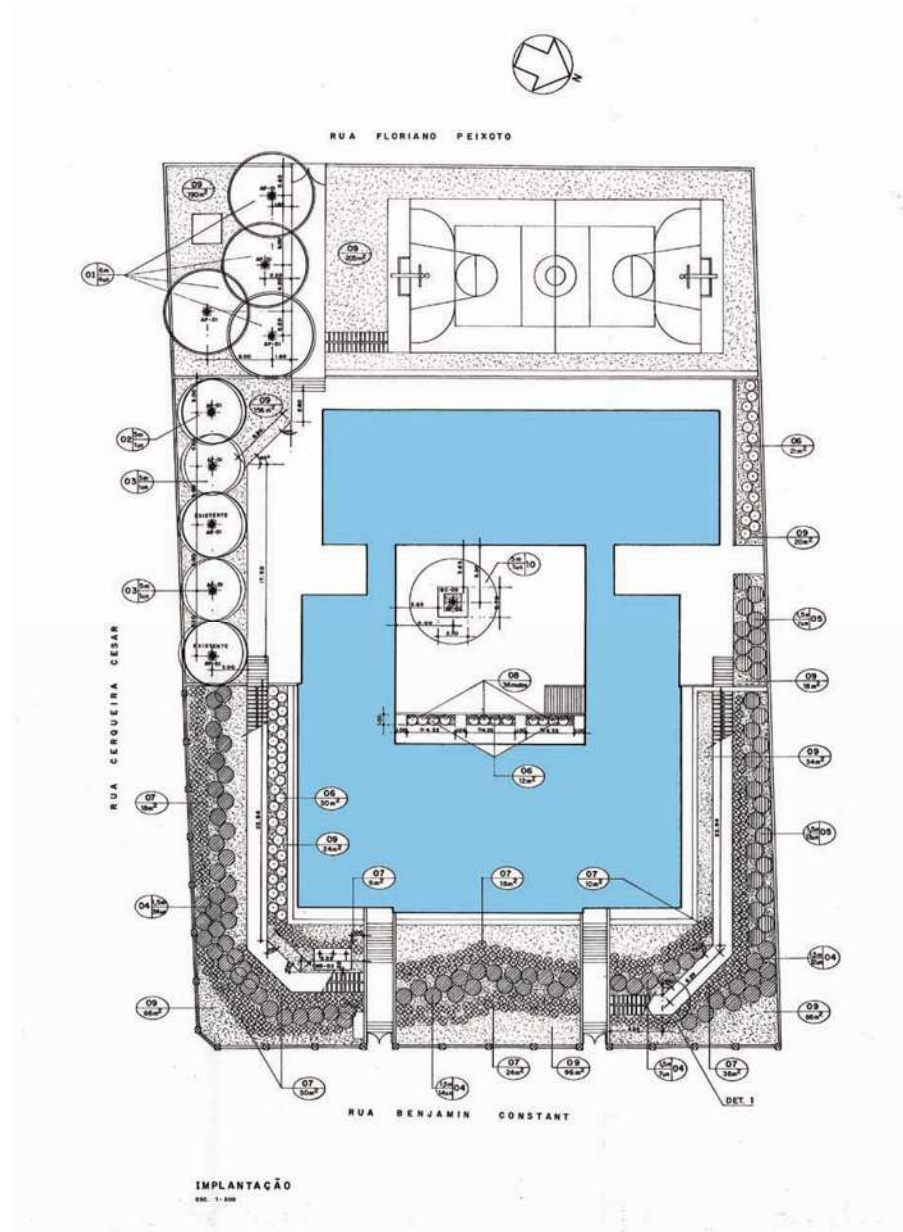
Implantação – proposta de intervenção. Fonte: arquivo do FDE.
